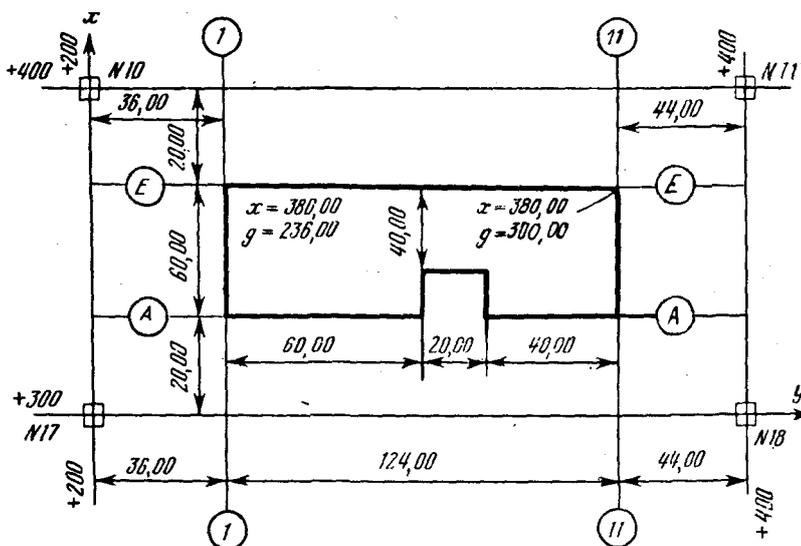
Схема разбивки основных осей здания от пунктов строительной сетки [6]
